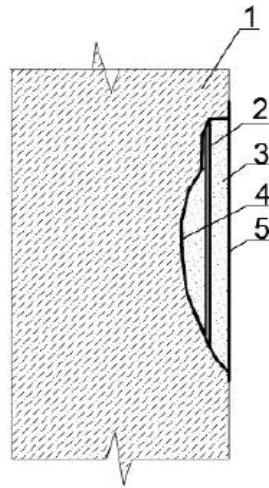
Схема технології ремонту бетонних та залізобетонних конструкцій нанесенням на пошкоджені поверхні ремонтного розчину вручну [1]: 1 – пошкоджена конструкція; 2 – арматура; 3 – ремонтний розчин; 4 – контактний шар; 5 – захисне покриття.
